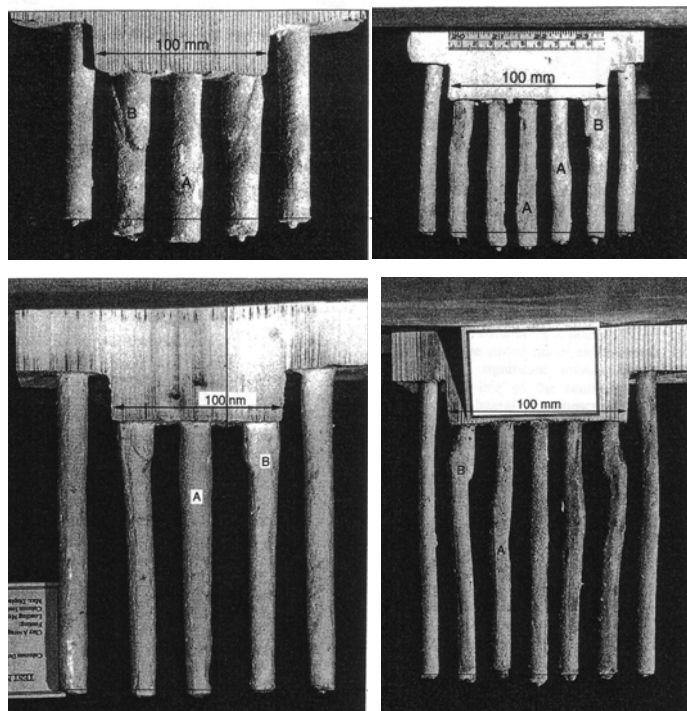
Deformación de las columnas al final del ensayo (Muir Wood et al., 2000)
